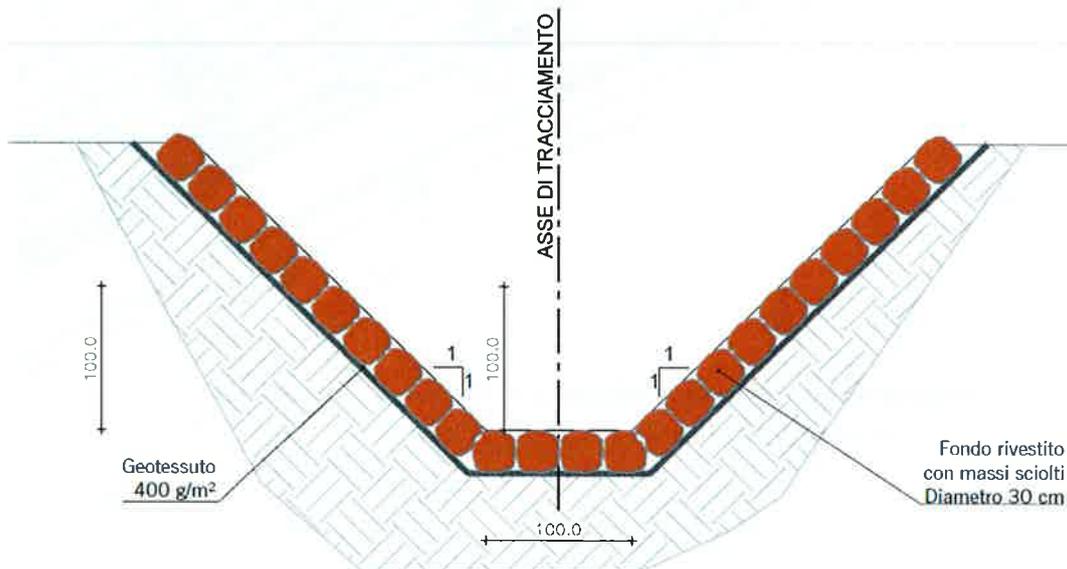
Inalveazione IN05 – canale di valle a sezione trapezia. Sezione tipologica
